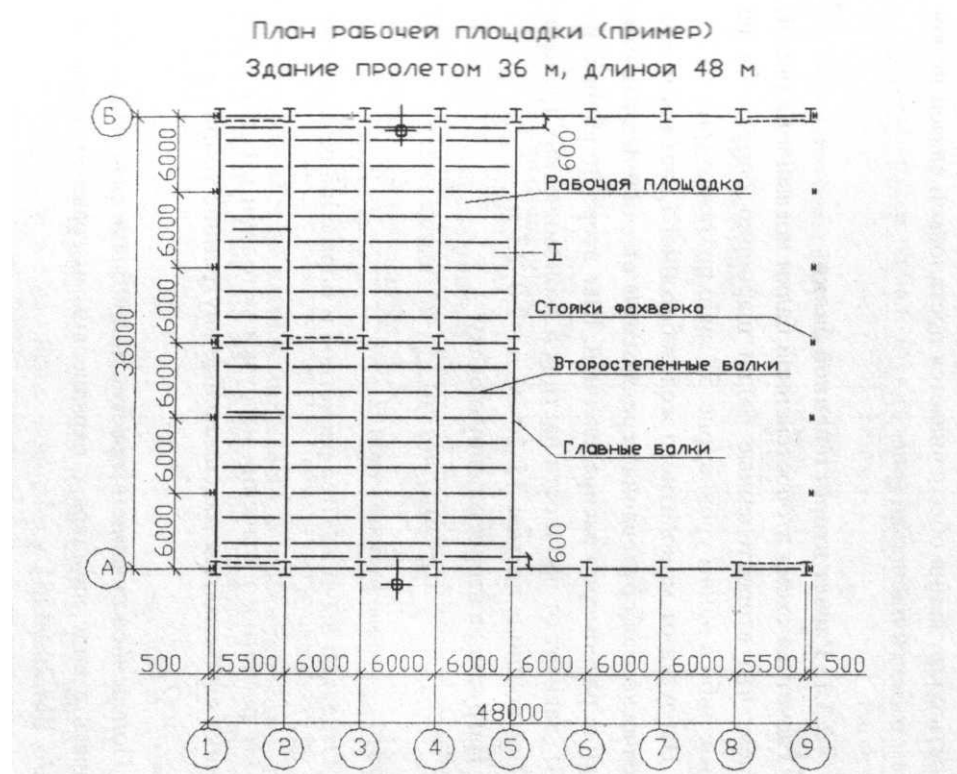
План балочной клетки в здании пролетом 36 м. Шаг второстепенных балок 2 м
